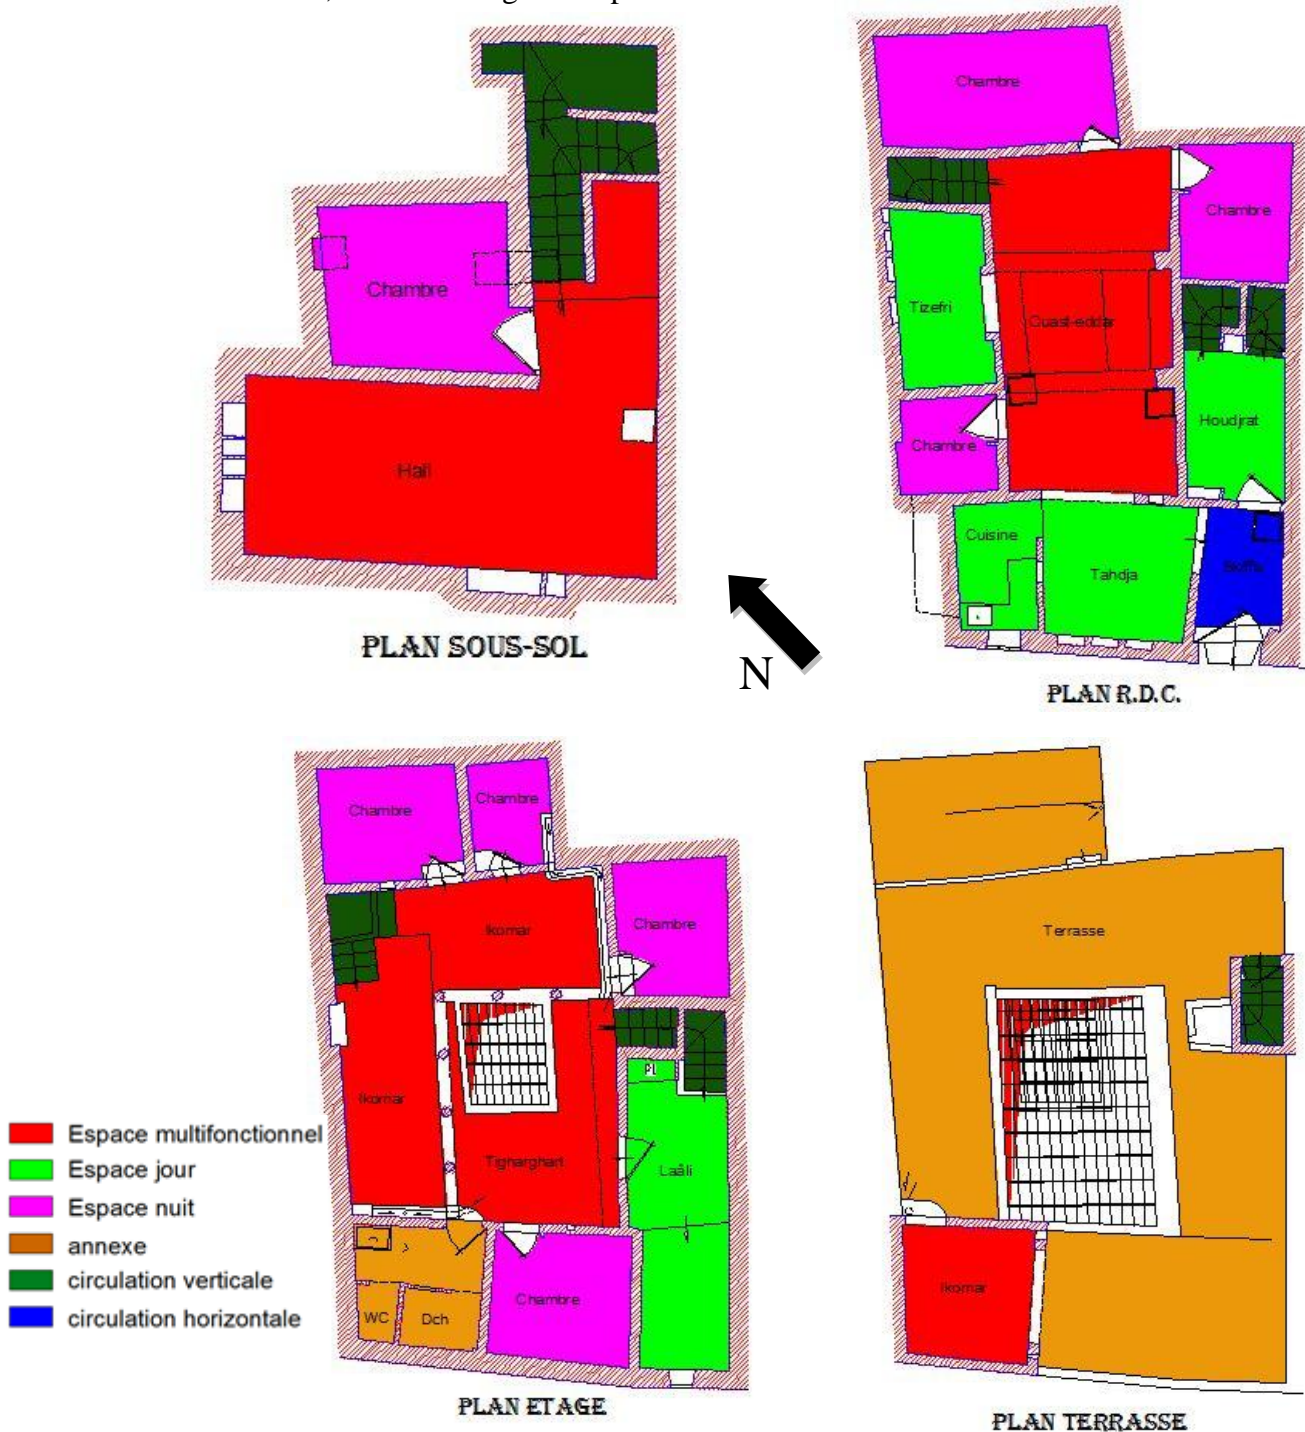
plan d'une maison traditionnel ech : 1/50. [29]
